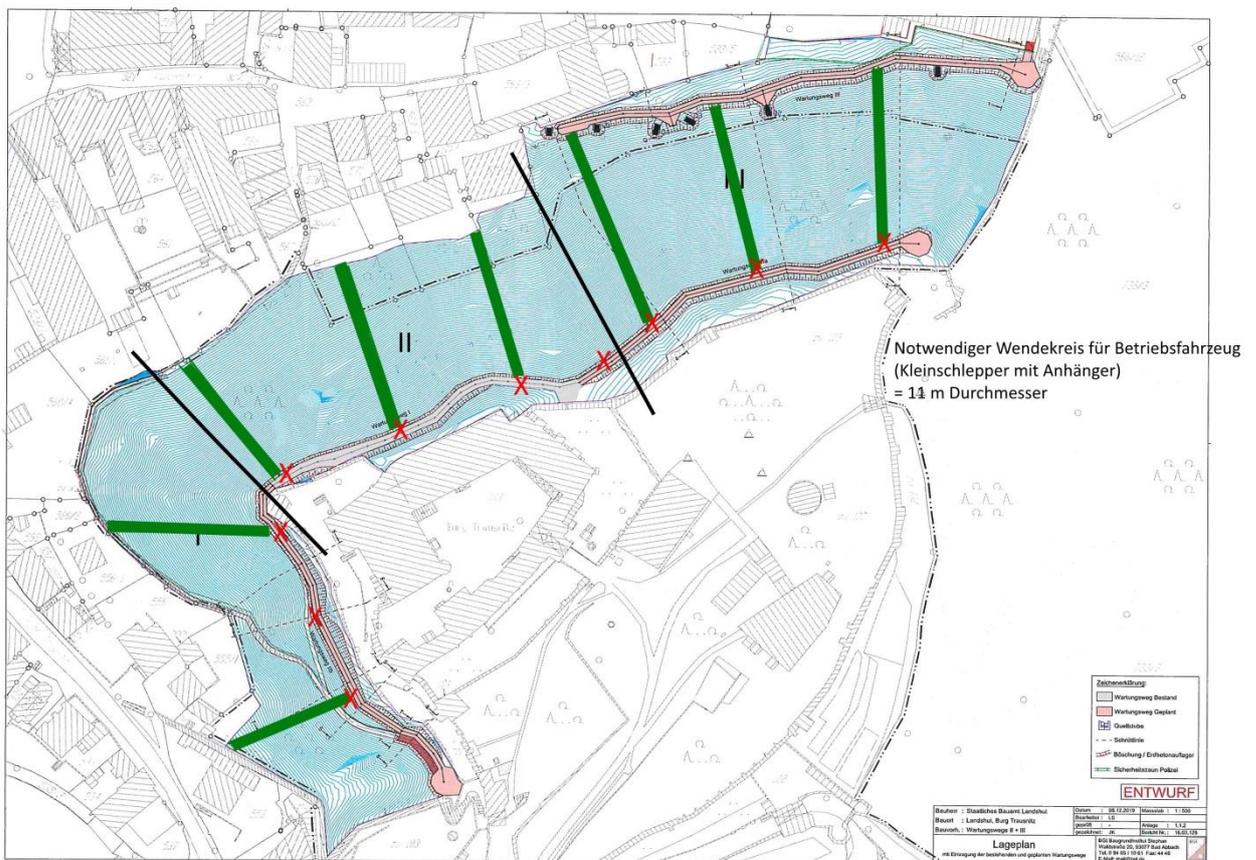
Lageplan mit Haltepunkten gem. BVLA. siehe Ordner-Punkt 4: „Aktenvermerke + Stellungnahmen“
